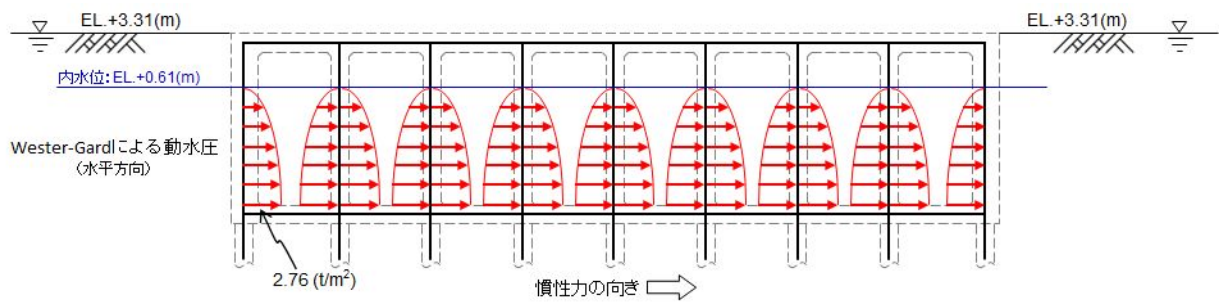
(1) 水平動による動水圧図 (①-①断面)
